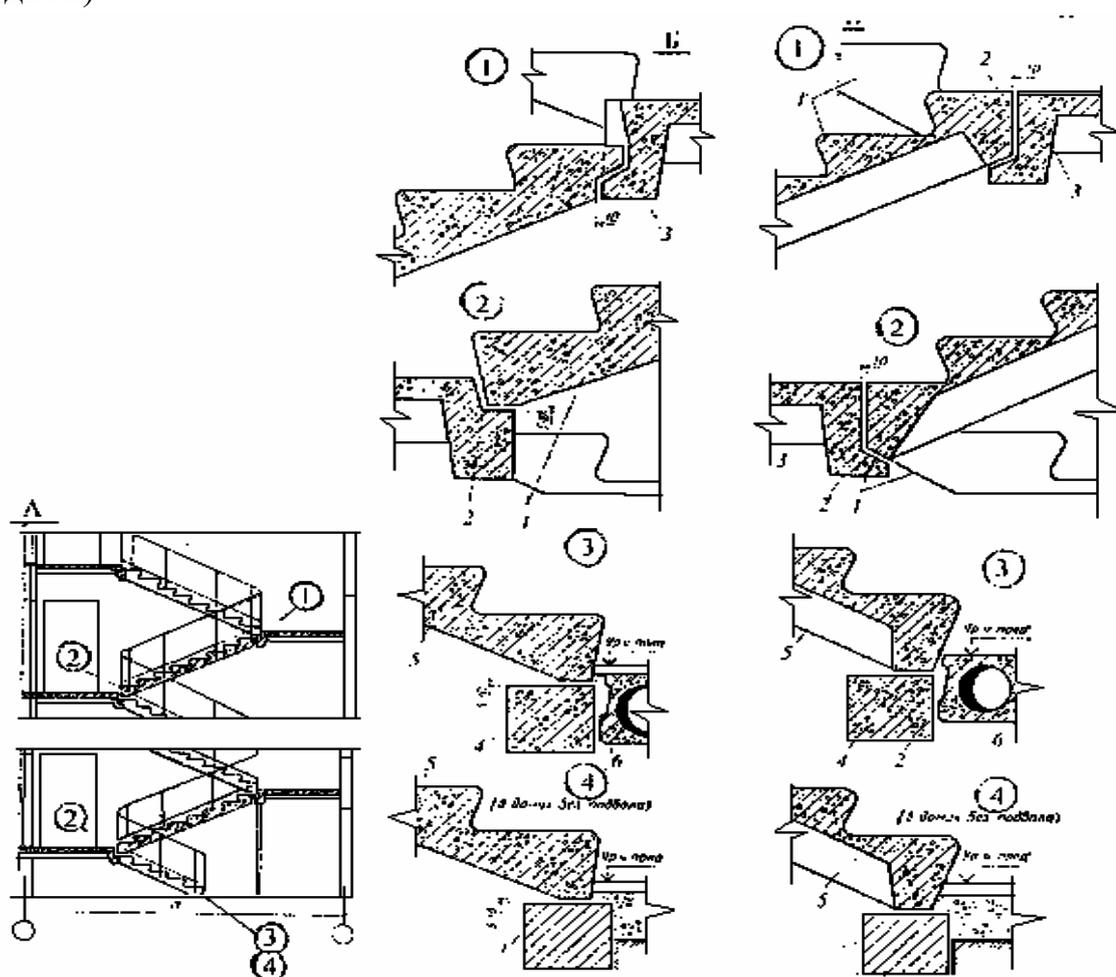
Примеры монтажных схем и узлов лестничных клеток в панельных бескаркасных зданиях: 1 – этажная лестничная площадка; 2 – междуэтажная площадка; 3 – наружная стеновая панель; 4 – панель внутренней стены; 5 – электропанель; 6 – панель перекрытия; 7 – цементно-песчаный раствор; 8 – лестничные марши.
